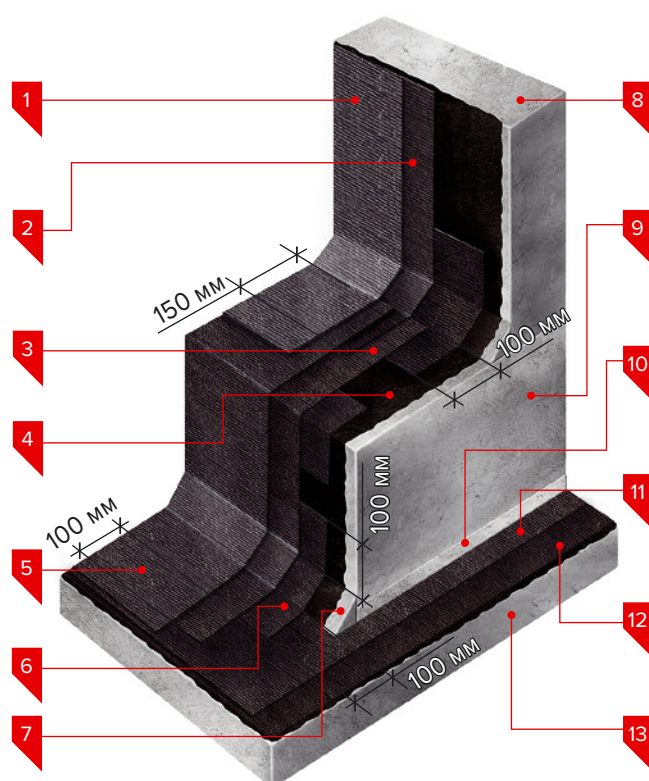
Техноэласт Фундамент. Зона подошвы фундамента:
